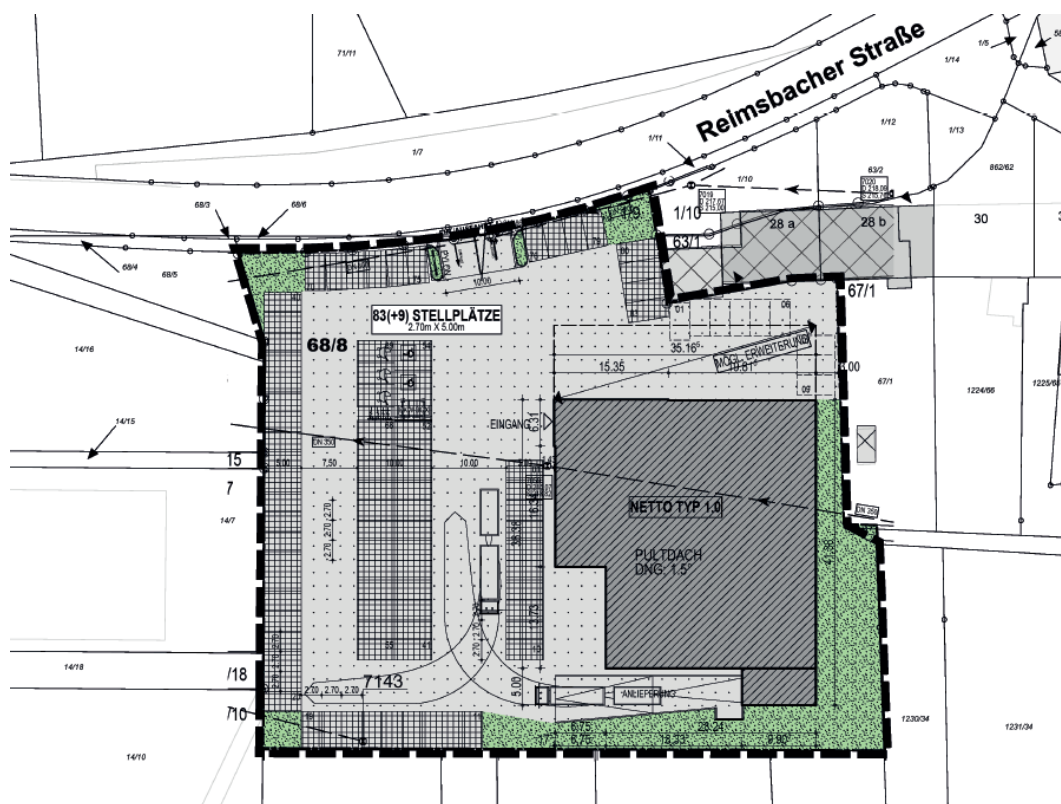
Ausschnitt B-Plan, Planungsbüro Kernplan [4]
